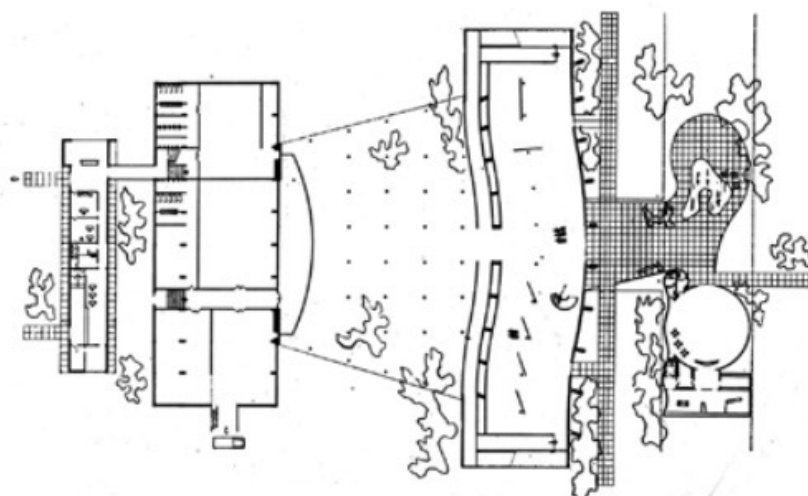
Planta-baixa do térreo. Fonte: MATOSO, 2008.
